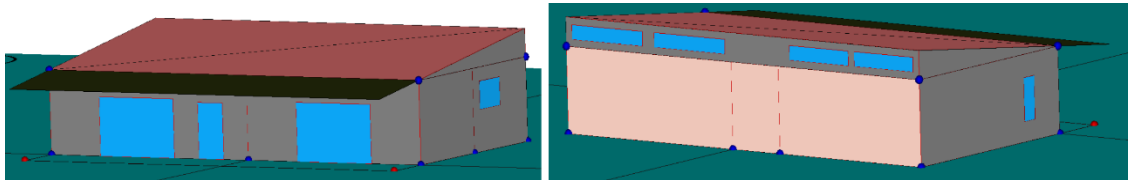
Fachadas delantera sur y trasera norte de la vivienda bioclimática diseñada
